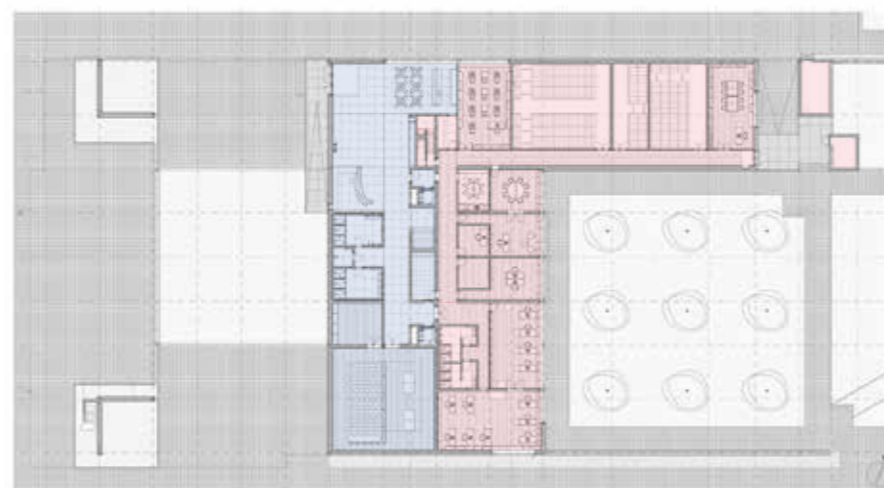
Esquema do sistema construtivo do primeiro piso.
